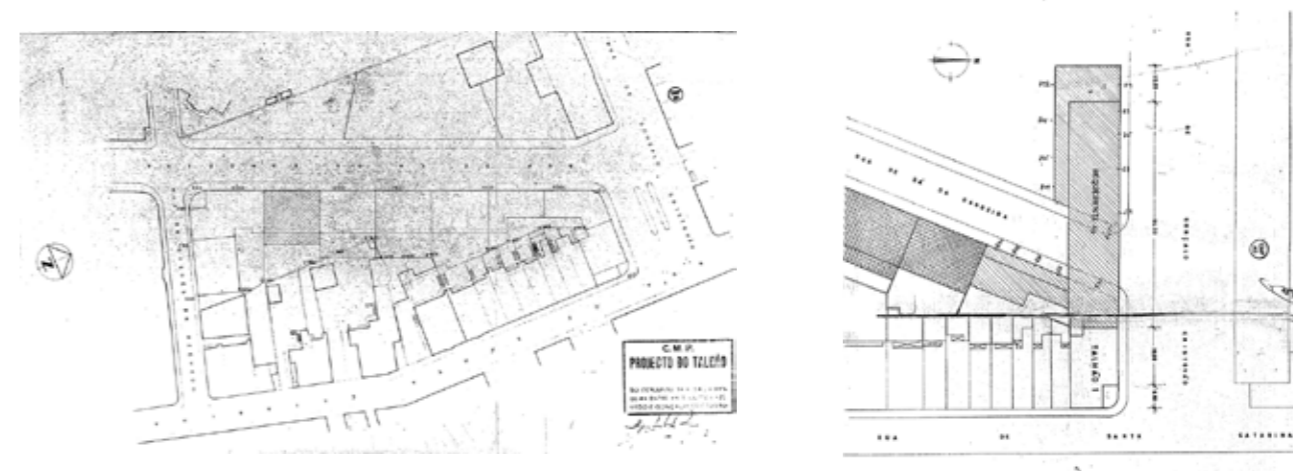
Planta de implantação do aditamento ao projecto de licenciamento 338 de 1958 para um lote na Rua de Sá da Bandeira
